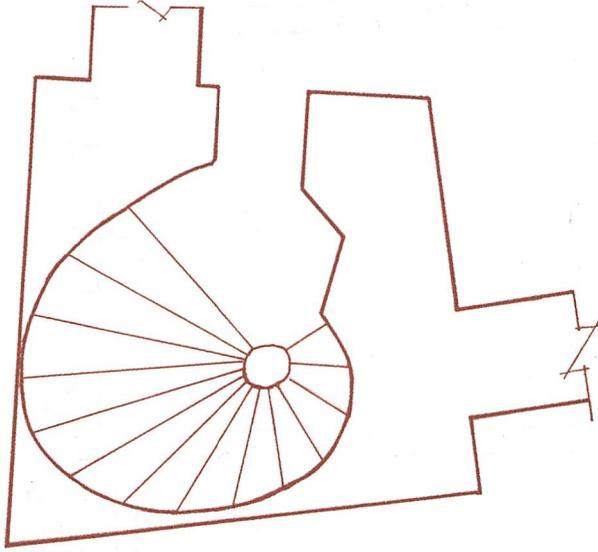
المسقط الأفقى لغرفة سبيل مسجد أبو مندور برشيد
